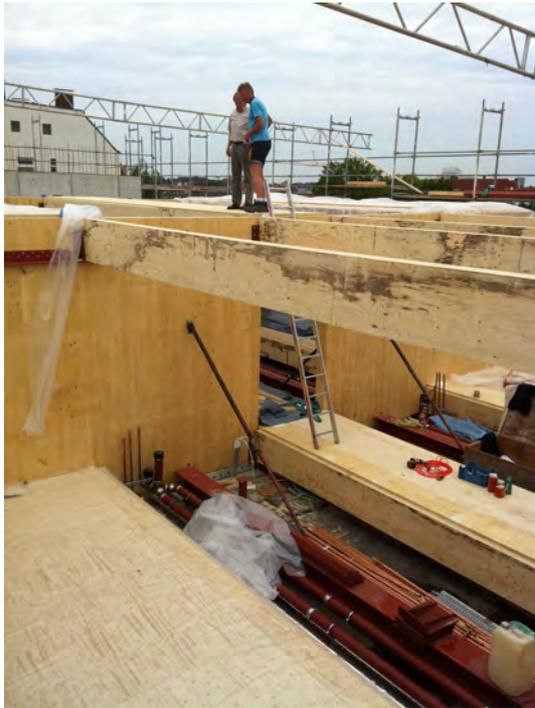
Dachaufstockung mit Brettspertholzplatten, Osterstrasse, 2013
